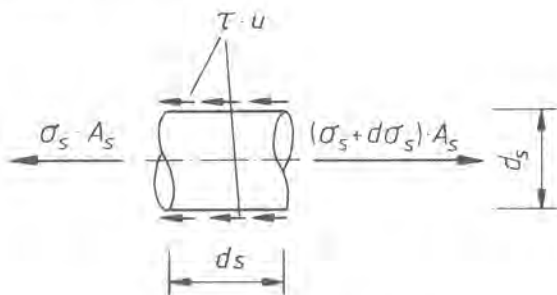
An einem Betonstahlabschnitt der Länge ds wirkende Kräfte
